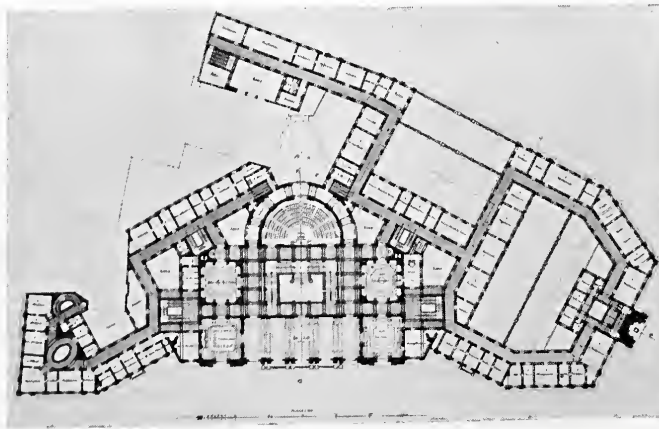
Grundriß vom II. Obergeschoß (Hauptgeschoß). Entwurf des Architekten Alfred Haushild in Dresden. (II. Preis.)
